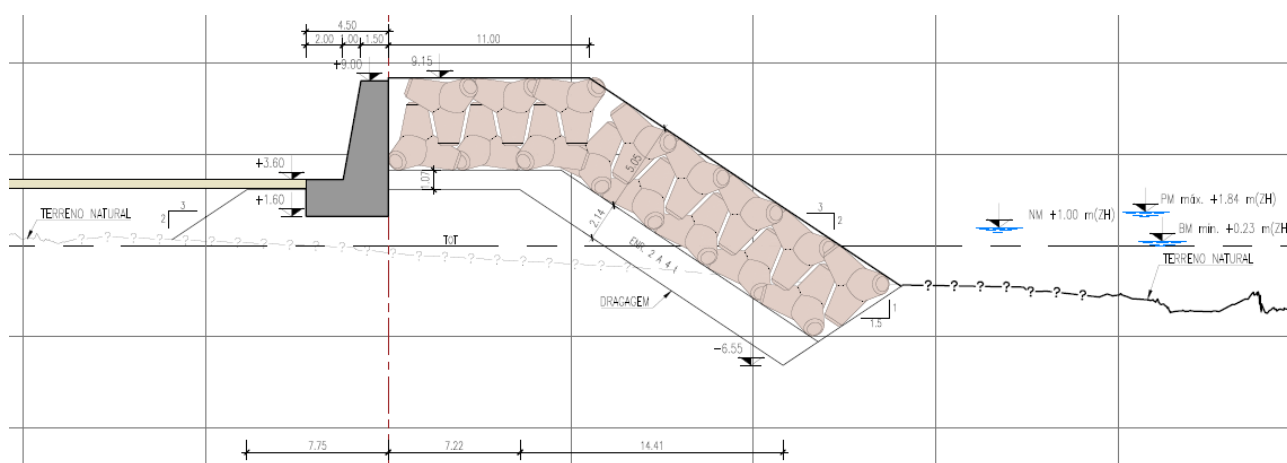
Obra de proteção costeira. Perfil tipo entre o enraizamento e o perfil PM 0+150, aproximadamente.
